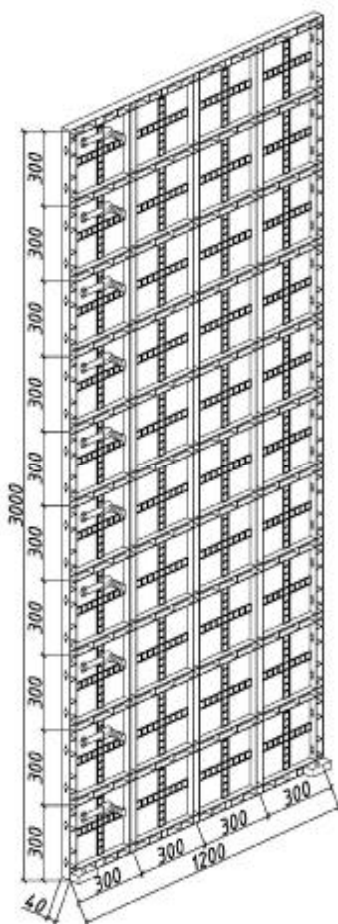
Разработанная модель крупнощитовой пластиковой опалубки для бетонирования стен из пенополистиролбетонной смеси
